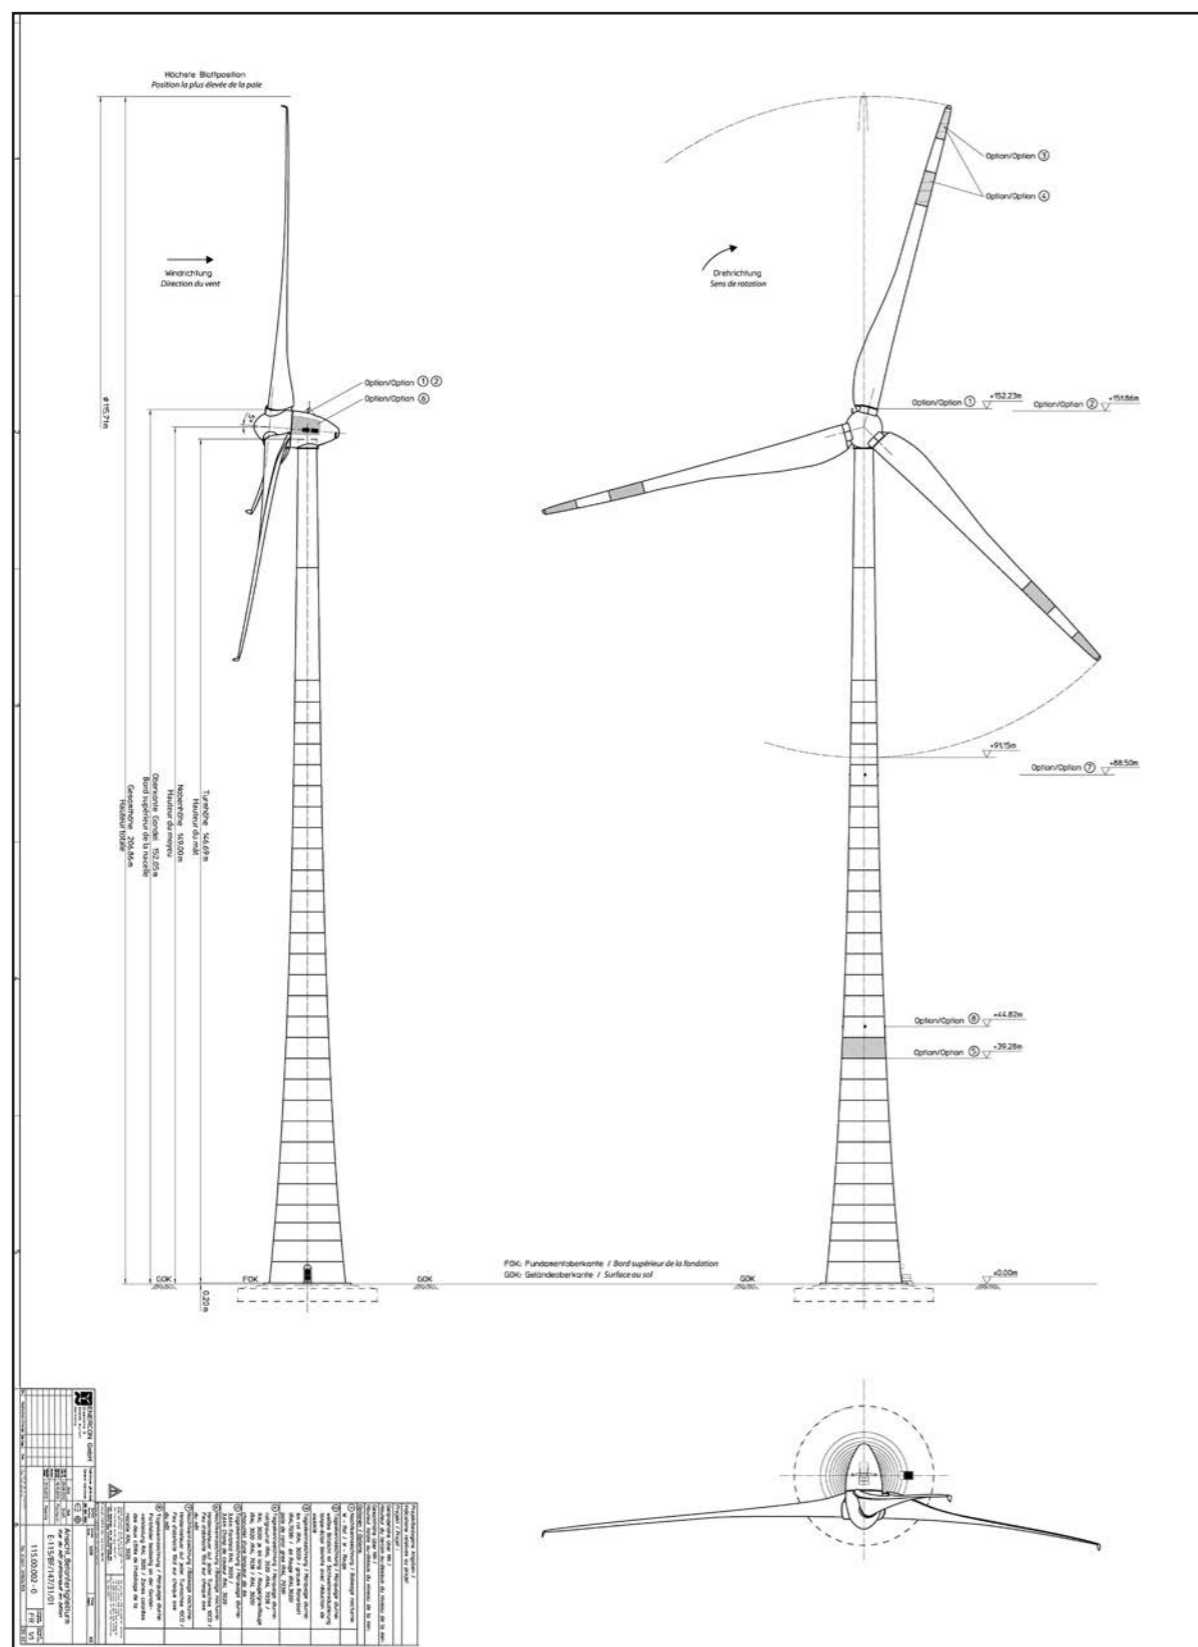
Plan de façade et profil d'une éolienne E-115, tour de 147 mètres
